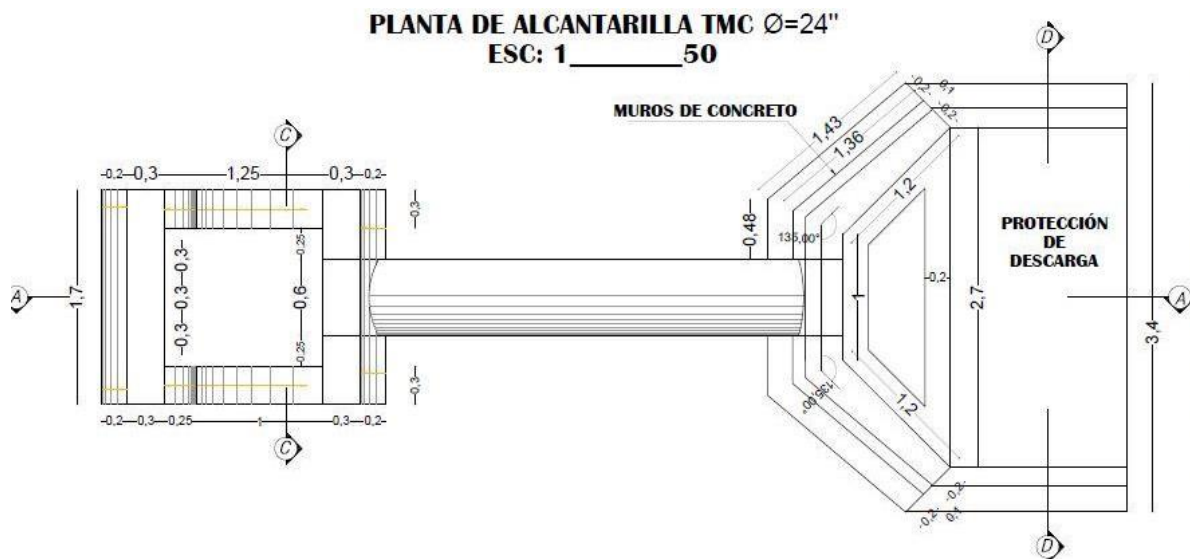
Detalle Alcantarilla en planta con respectivas dimensiones.
